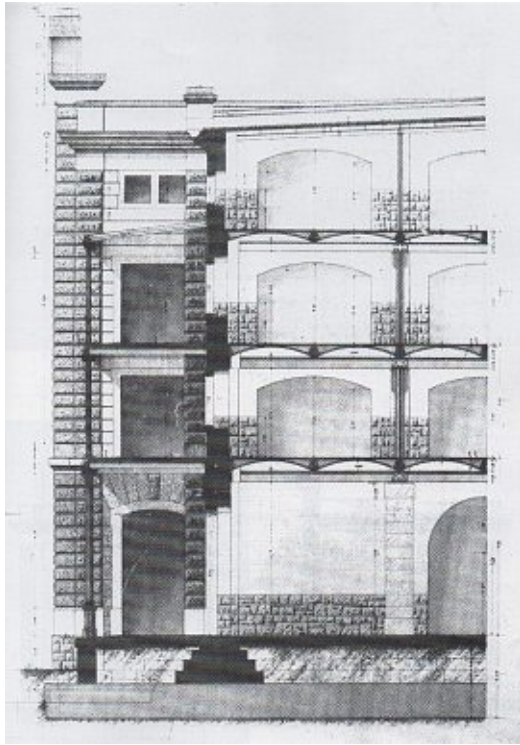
Schnitt des Lagerhauses 10. In diesem Plan ist die Anwendung der Melanbauweise für die Errichtung der Geschossdecken klar erkennbar. Die in den Lagerhäusern 10 und 20 verwendete Variante ist eine Änderung des originalen Patentes durch Ingenieur Geiringer. Diese neue Variante verwendet vorfabrizierte Gewölbestructuren, die die sekundären tragenden Elemente beinhalten.
